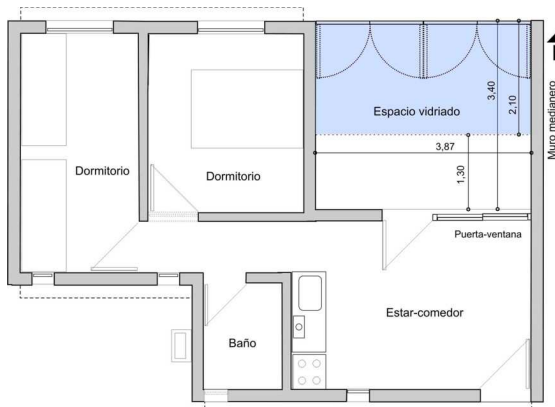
Planta de la vivienda con incorporación del espacio vidriado
